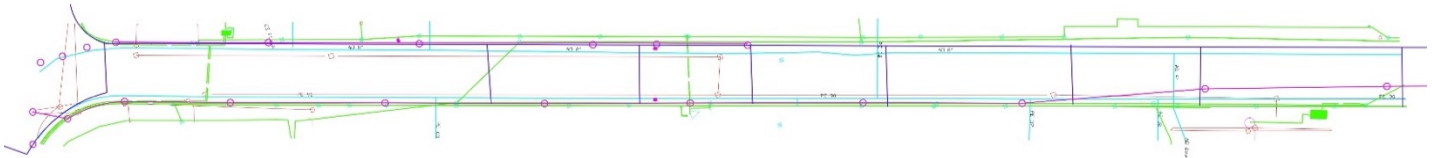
Planta general y detalle de las infraestructuras existentes en la avenida Norte de Castilla. Fuente: Boriana Christova (Land Art Studio 2002).
